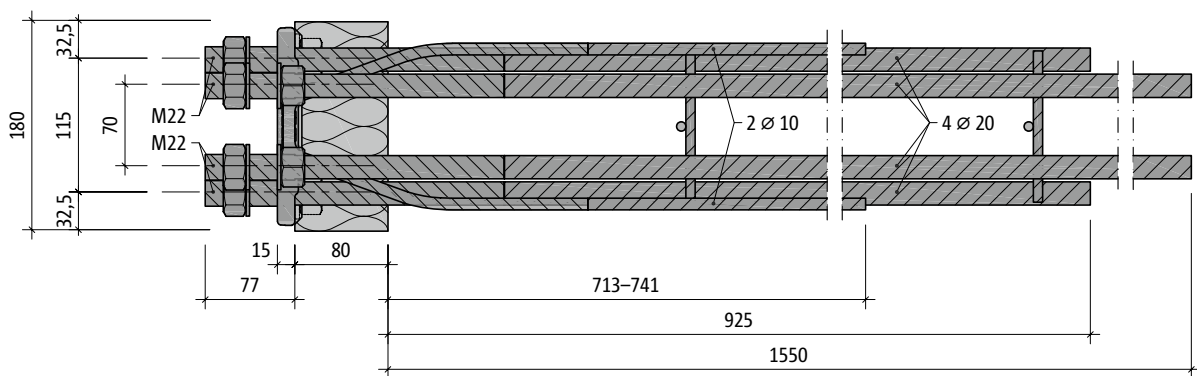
Schöck Isokorb® T type SK-MM2-VV1 : plan de base
